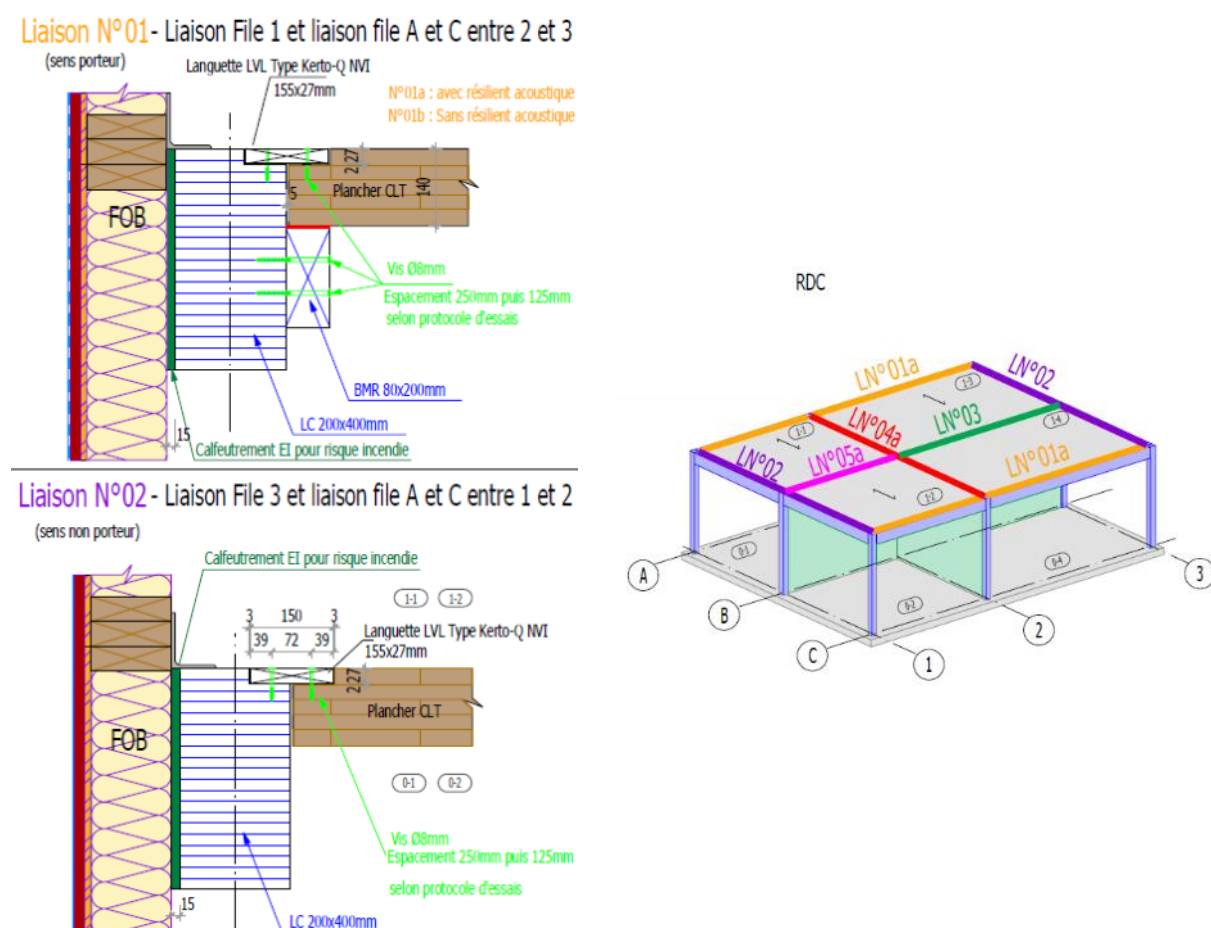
Vue des jonctions en T plancher façade entre le RdC et le R+1.
